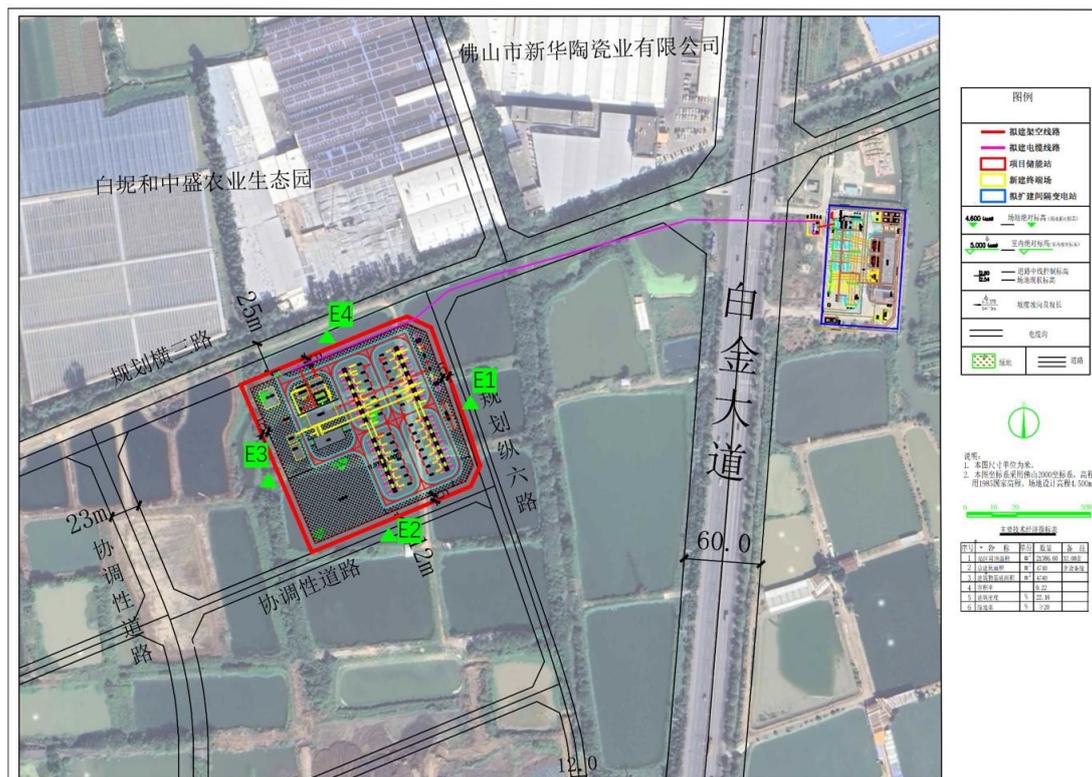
佛山三水储能电站平面布置示意图及监测点位布置图
